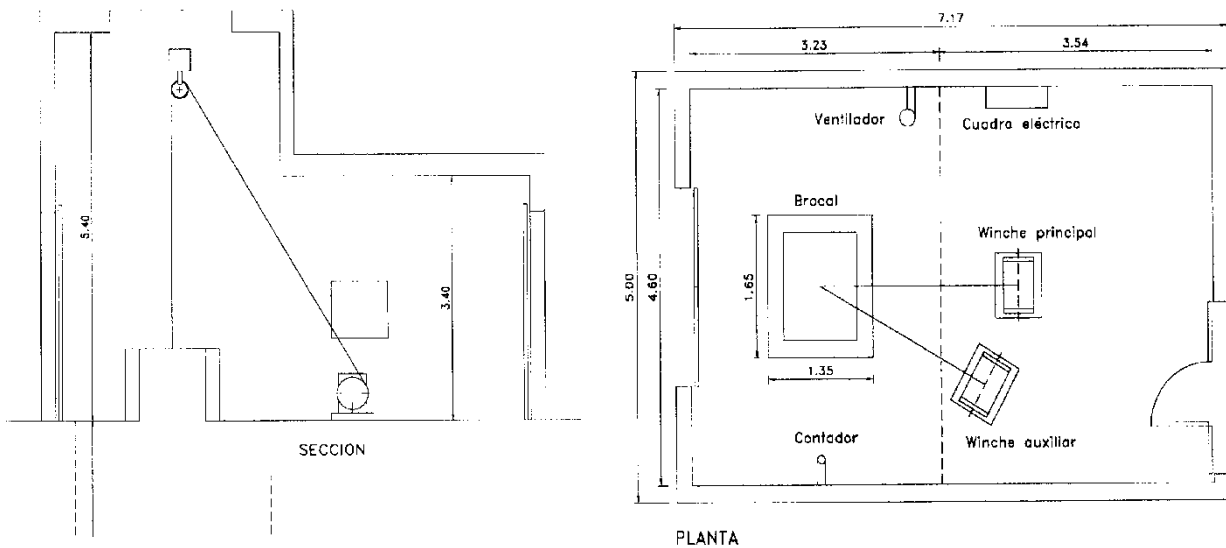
Planta y sección tipo de la casa de máquinas (Martín, 1997)
